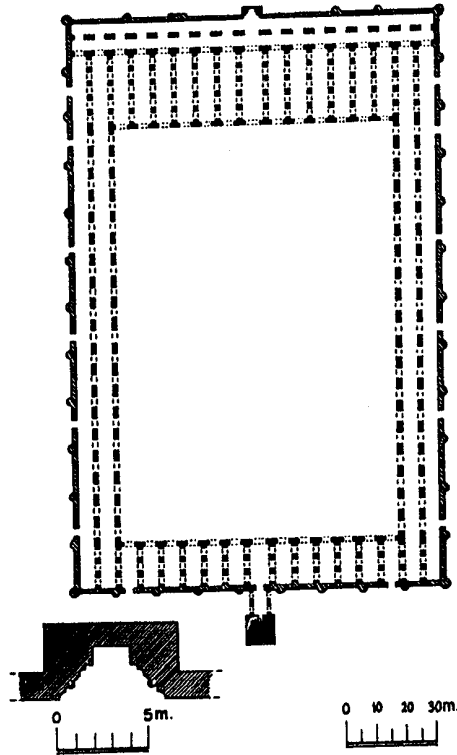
مسقط أفقي للجامع الكبير (اولو جامع) في سيواس (عن : Aslanapa)
